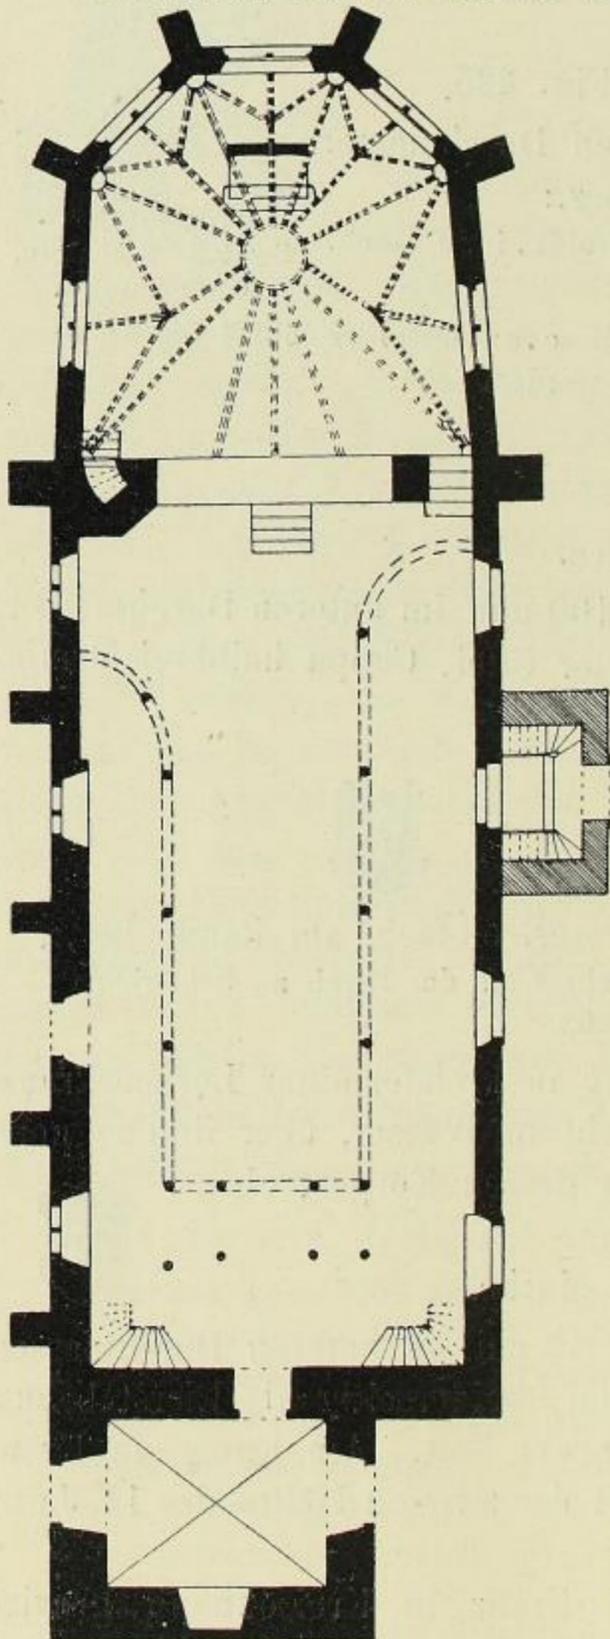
Schönfeld, Grundriss der Kirche.
